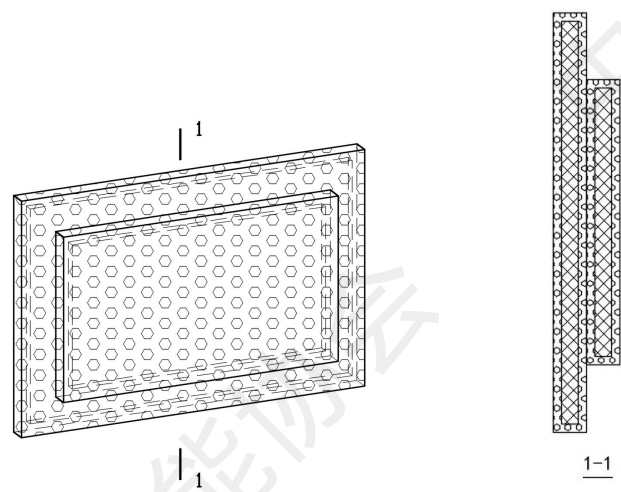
双层真空绝热复合保温板构造示意图
